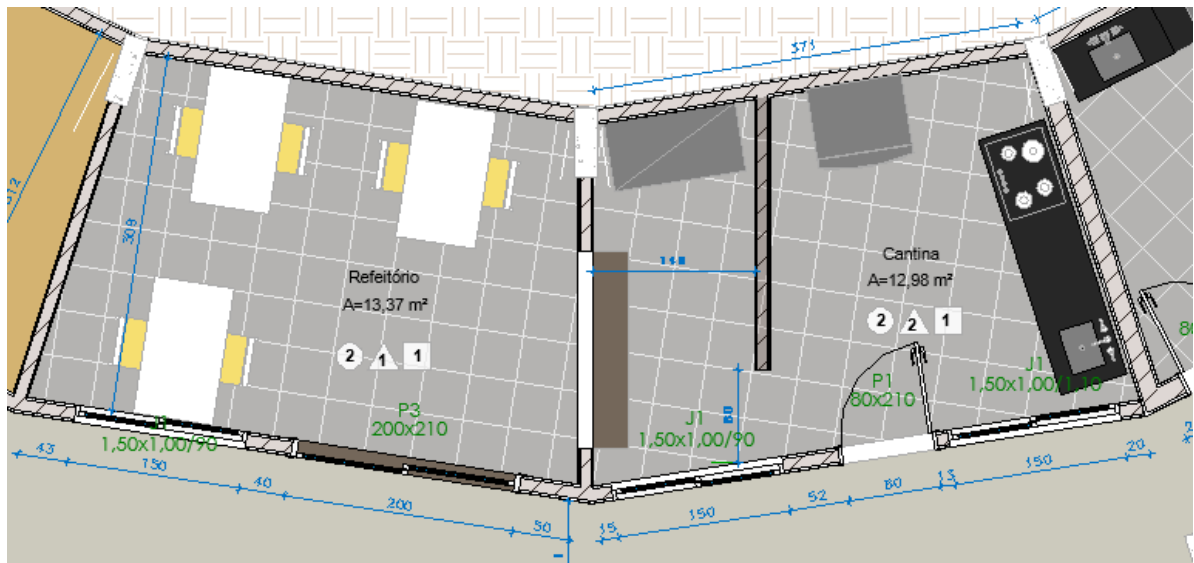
Parede das salas embaixo da arquibancada recuadas
